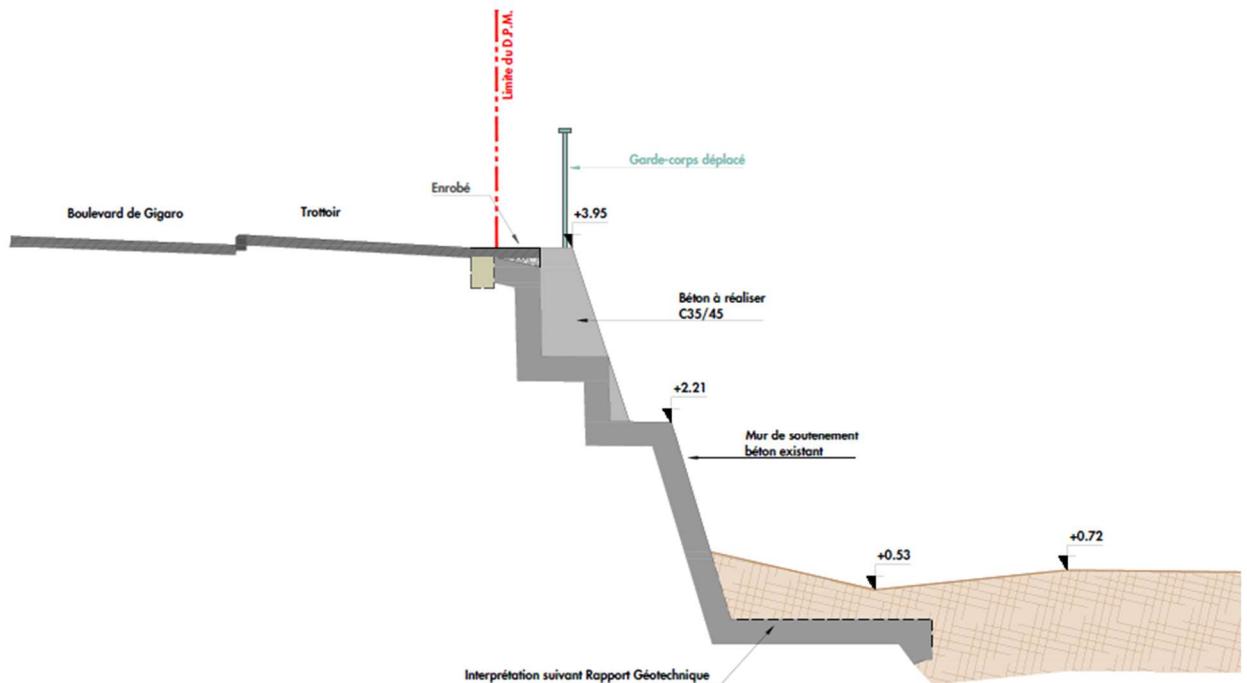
Zone 1 / Coupe type 2 (mur projet sur existant)
